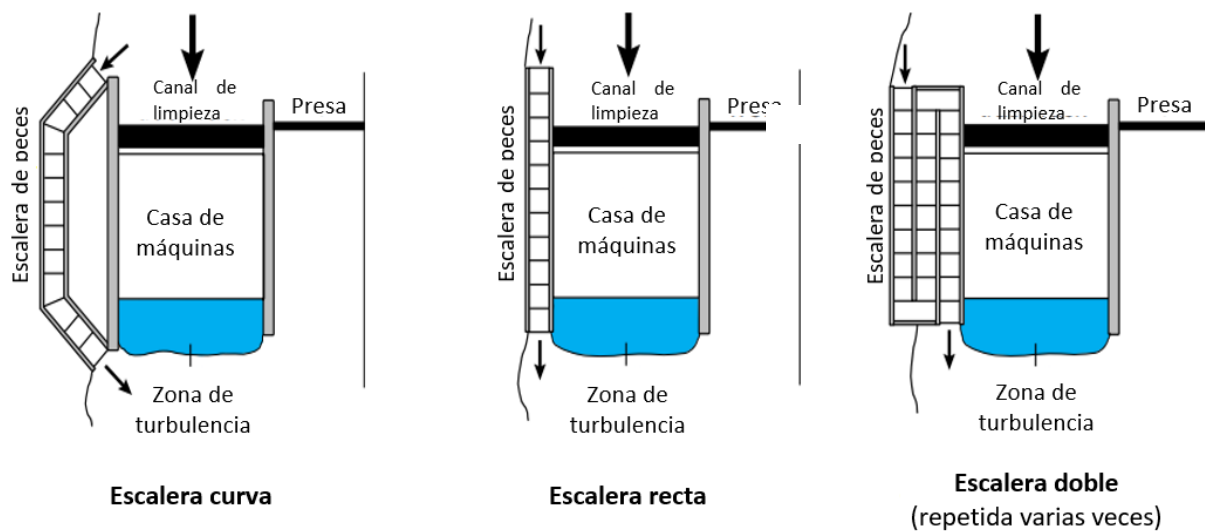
Vista superior de la disposición de una escalera tipo artesa
